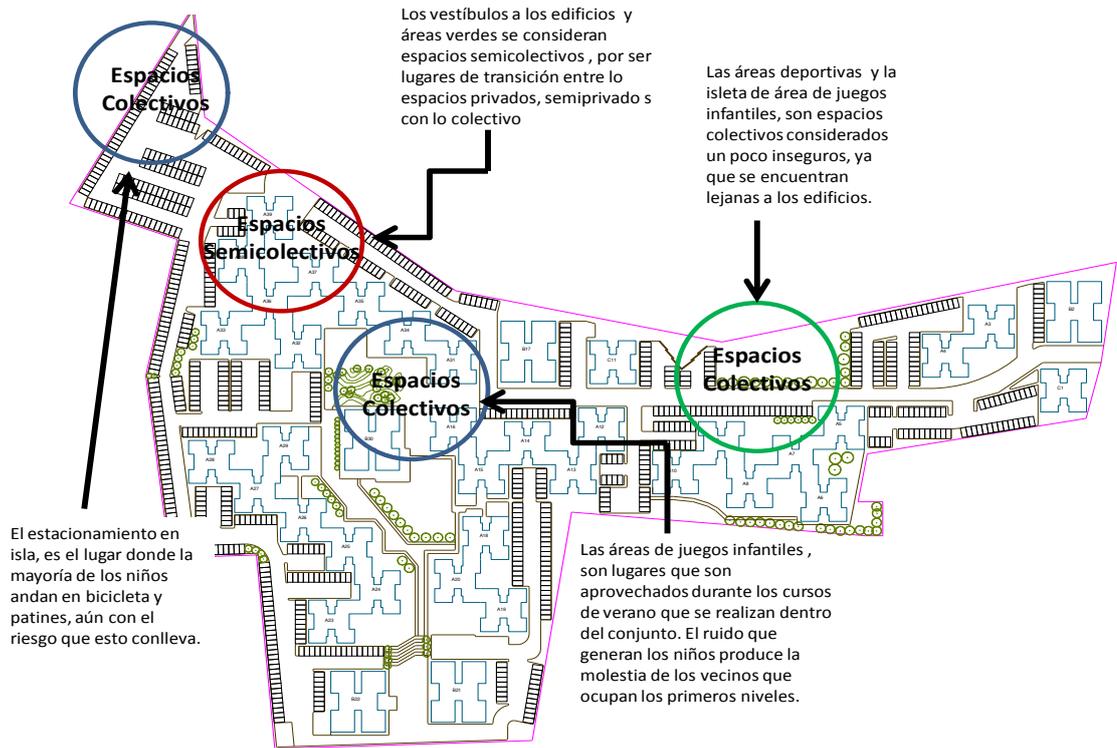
Plano de conjunto de autoría propia para explicar la interacción socio-espacial de los niños con el espacio inmediato comunitario. Fuente: autoría propia, ya que fue imposible obtener los planos del conjunto.
